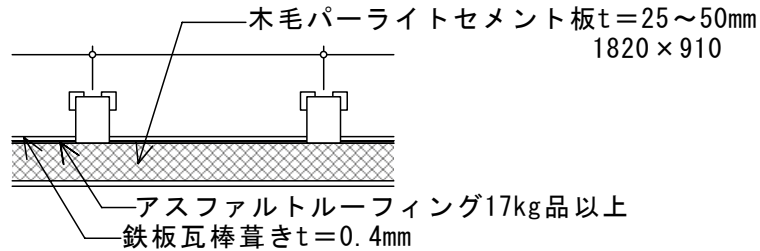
水平断面図 (金属下地 : 亜鉛鉄板瓦棒葺き)
